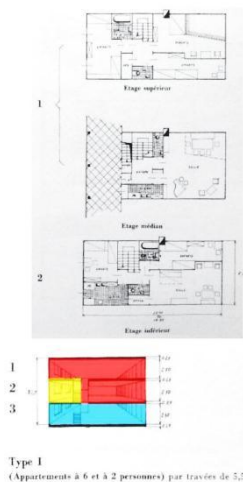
L'Ilot Insalubre*, planta do tipo 1, rua lateral
